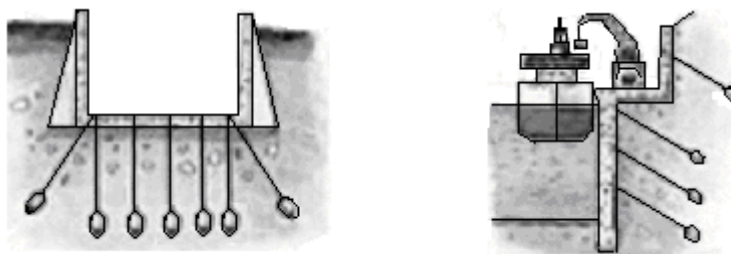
Примеры использования грунтовых анкеров в гидротехническом строительстве.
